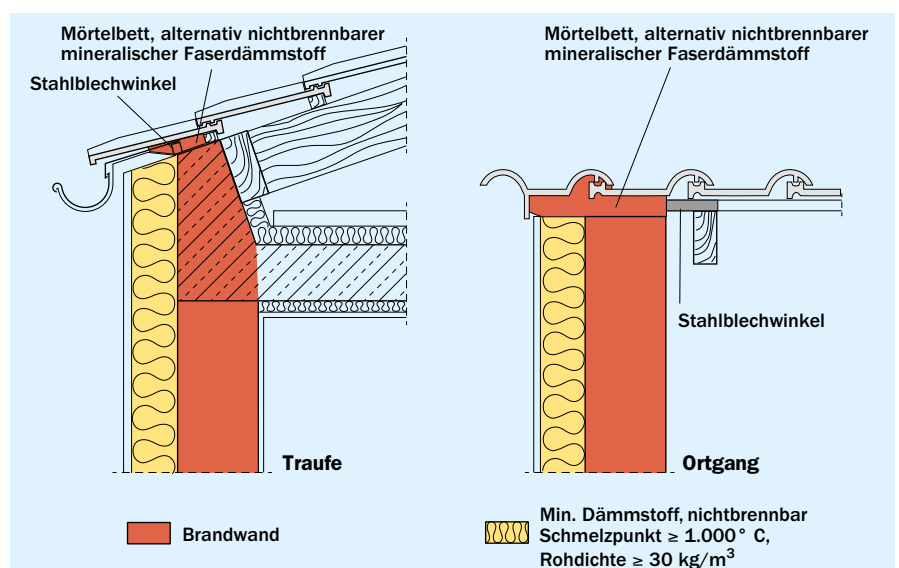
Dachanschlüsse – Traufe, Ortgang – bei Gebäudeabschlusswänden bei Grenzbebauung (Beispiele)
